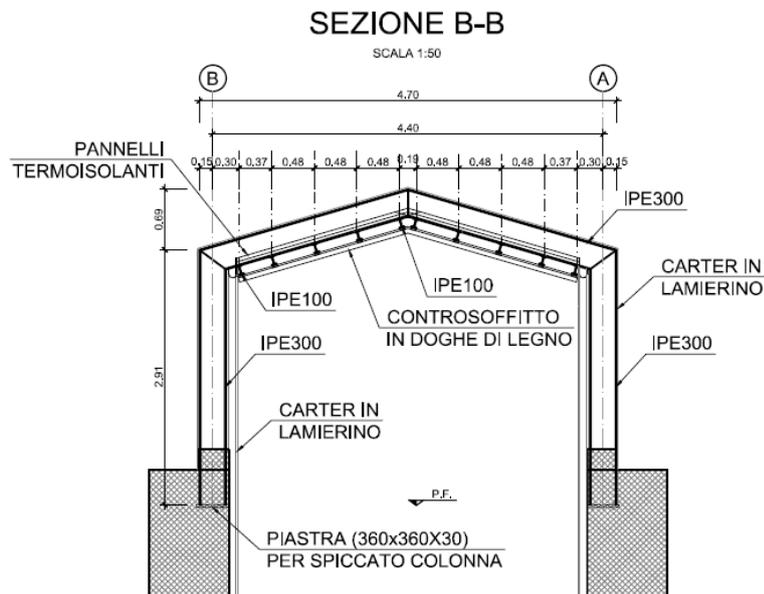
Shelter fabbricato Tecnologico nella stazione di Assisi: sezione trasversale
